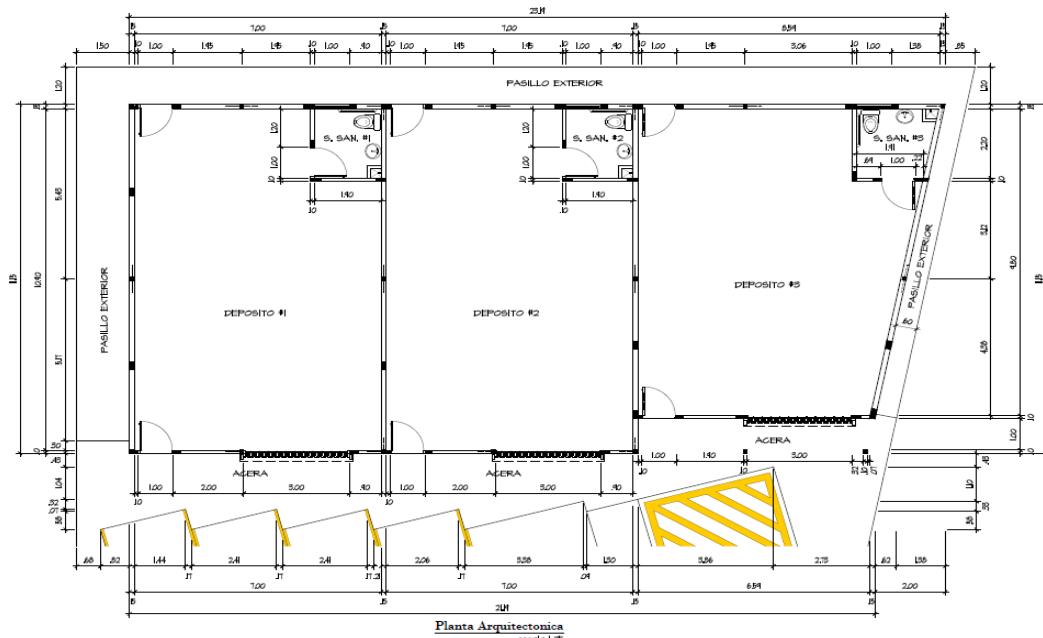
Planta arquitectónica del proyecto MINIDEPÓSITOS
